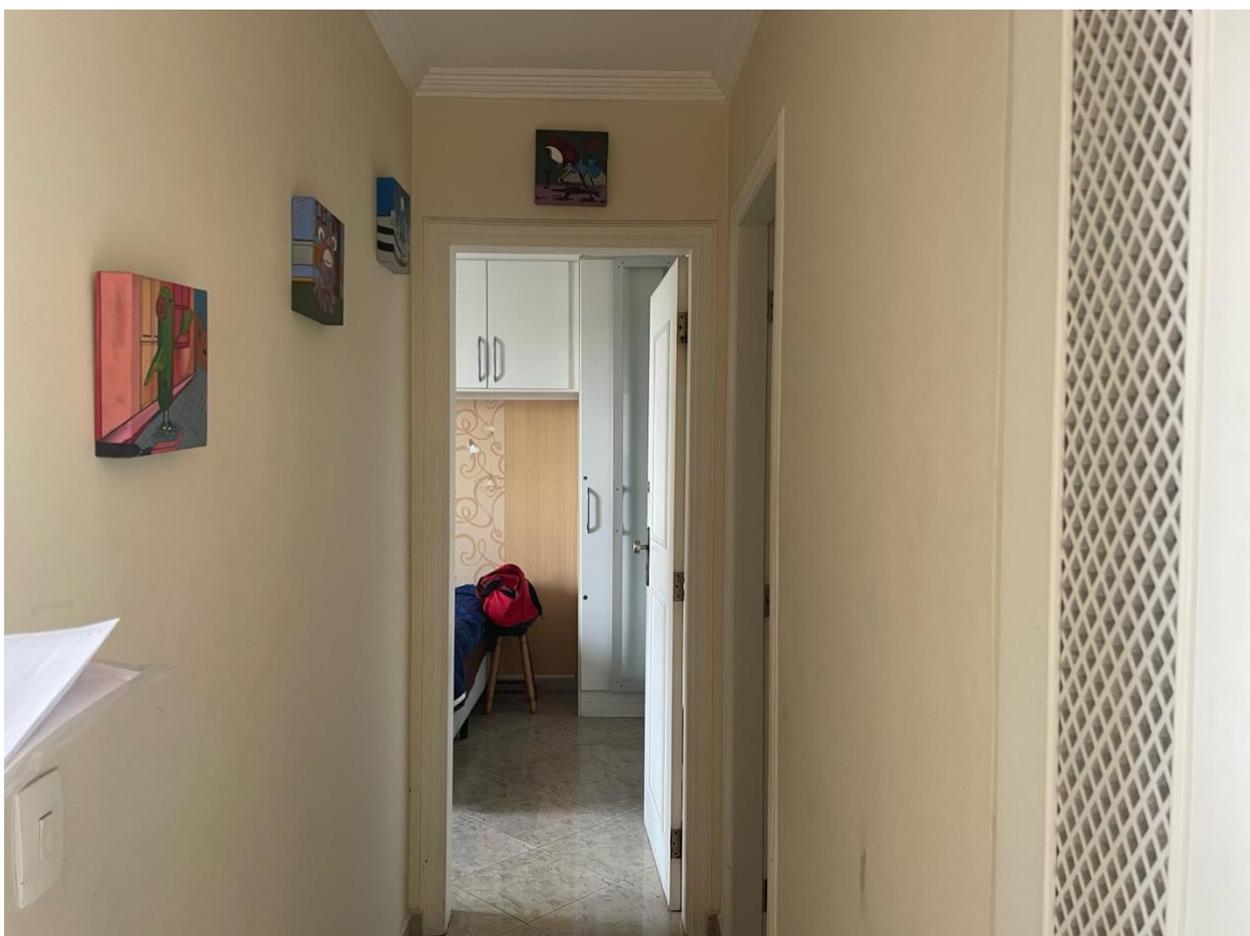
Vista do quarto da suíte com detalhe do armário no corredor
